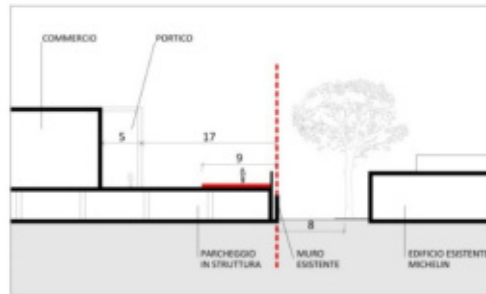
Stralcio planimetrico e dettaglio costruttivo parcheggio a raso
